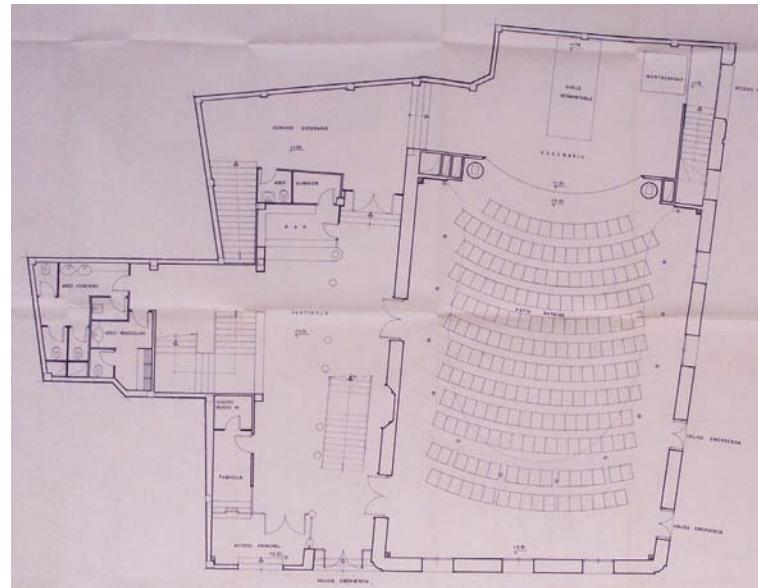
Plano de la planta baja del Teatro Principal. AMA legajo 2931.
